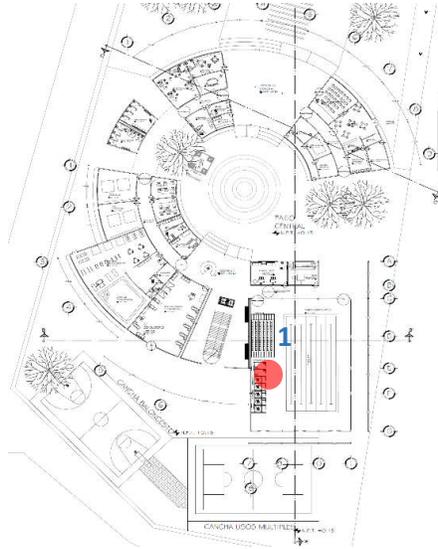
Vista de Planta Baja del Complejo, donde se ubica la posición de los muebles sanitarios (Regaderas).
